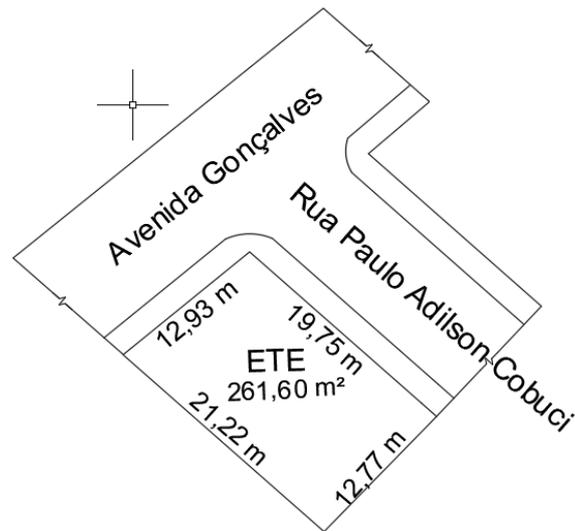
Informações do lote que vai ser implantado/construído a ETE
